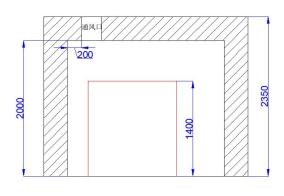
(b) 探伤室1-1剖面示意图(单位: mm)
